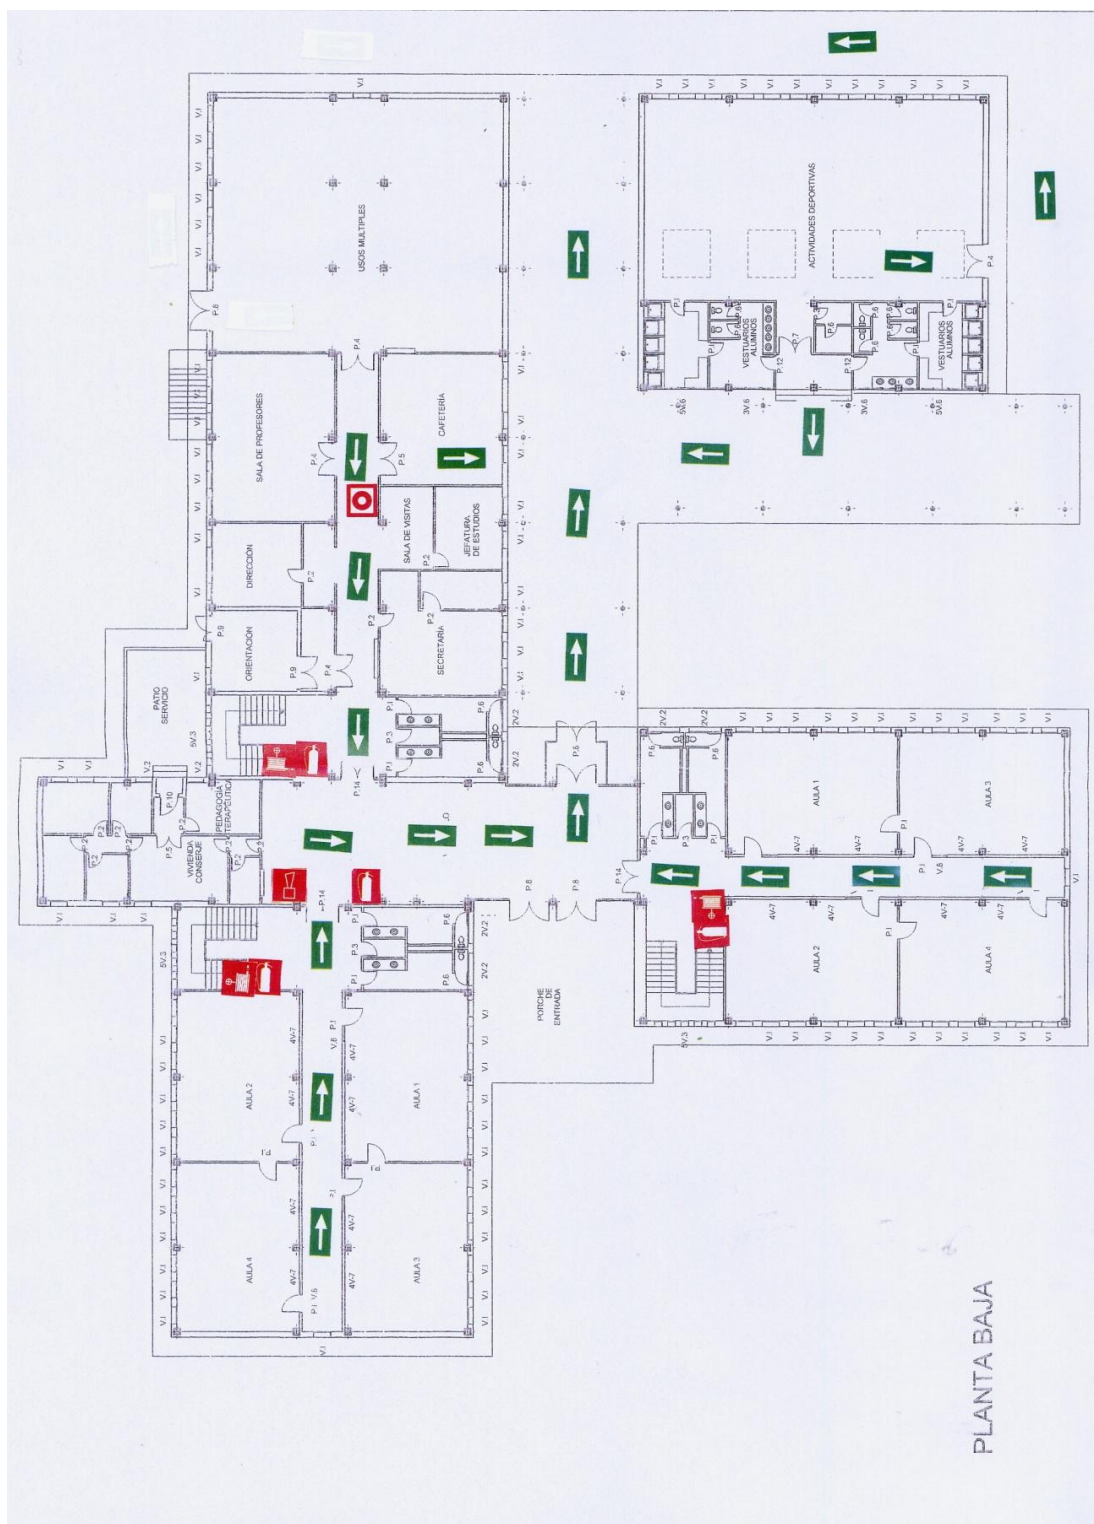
Plano evacuación planta baja. Fuente: I.E.S Cesar Manrique.
